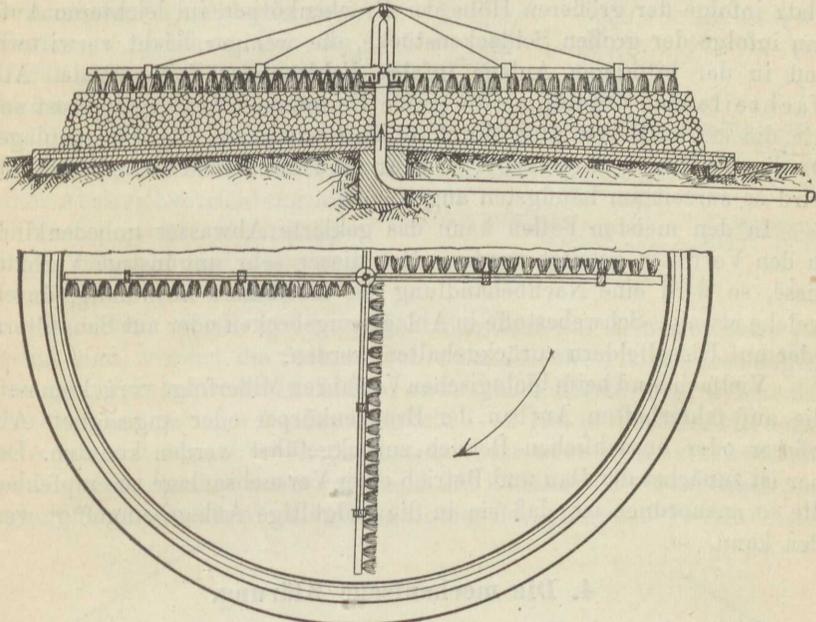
Tropfkörper mit Sprinklerberieselung.
